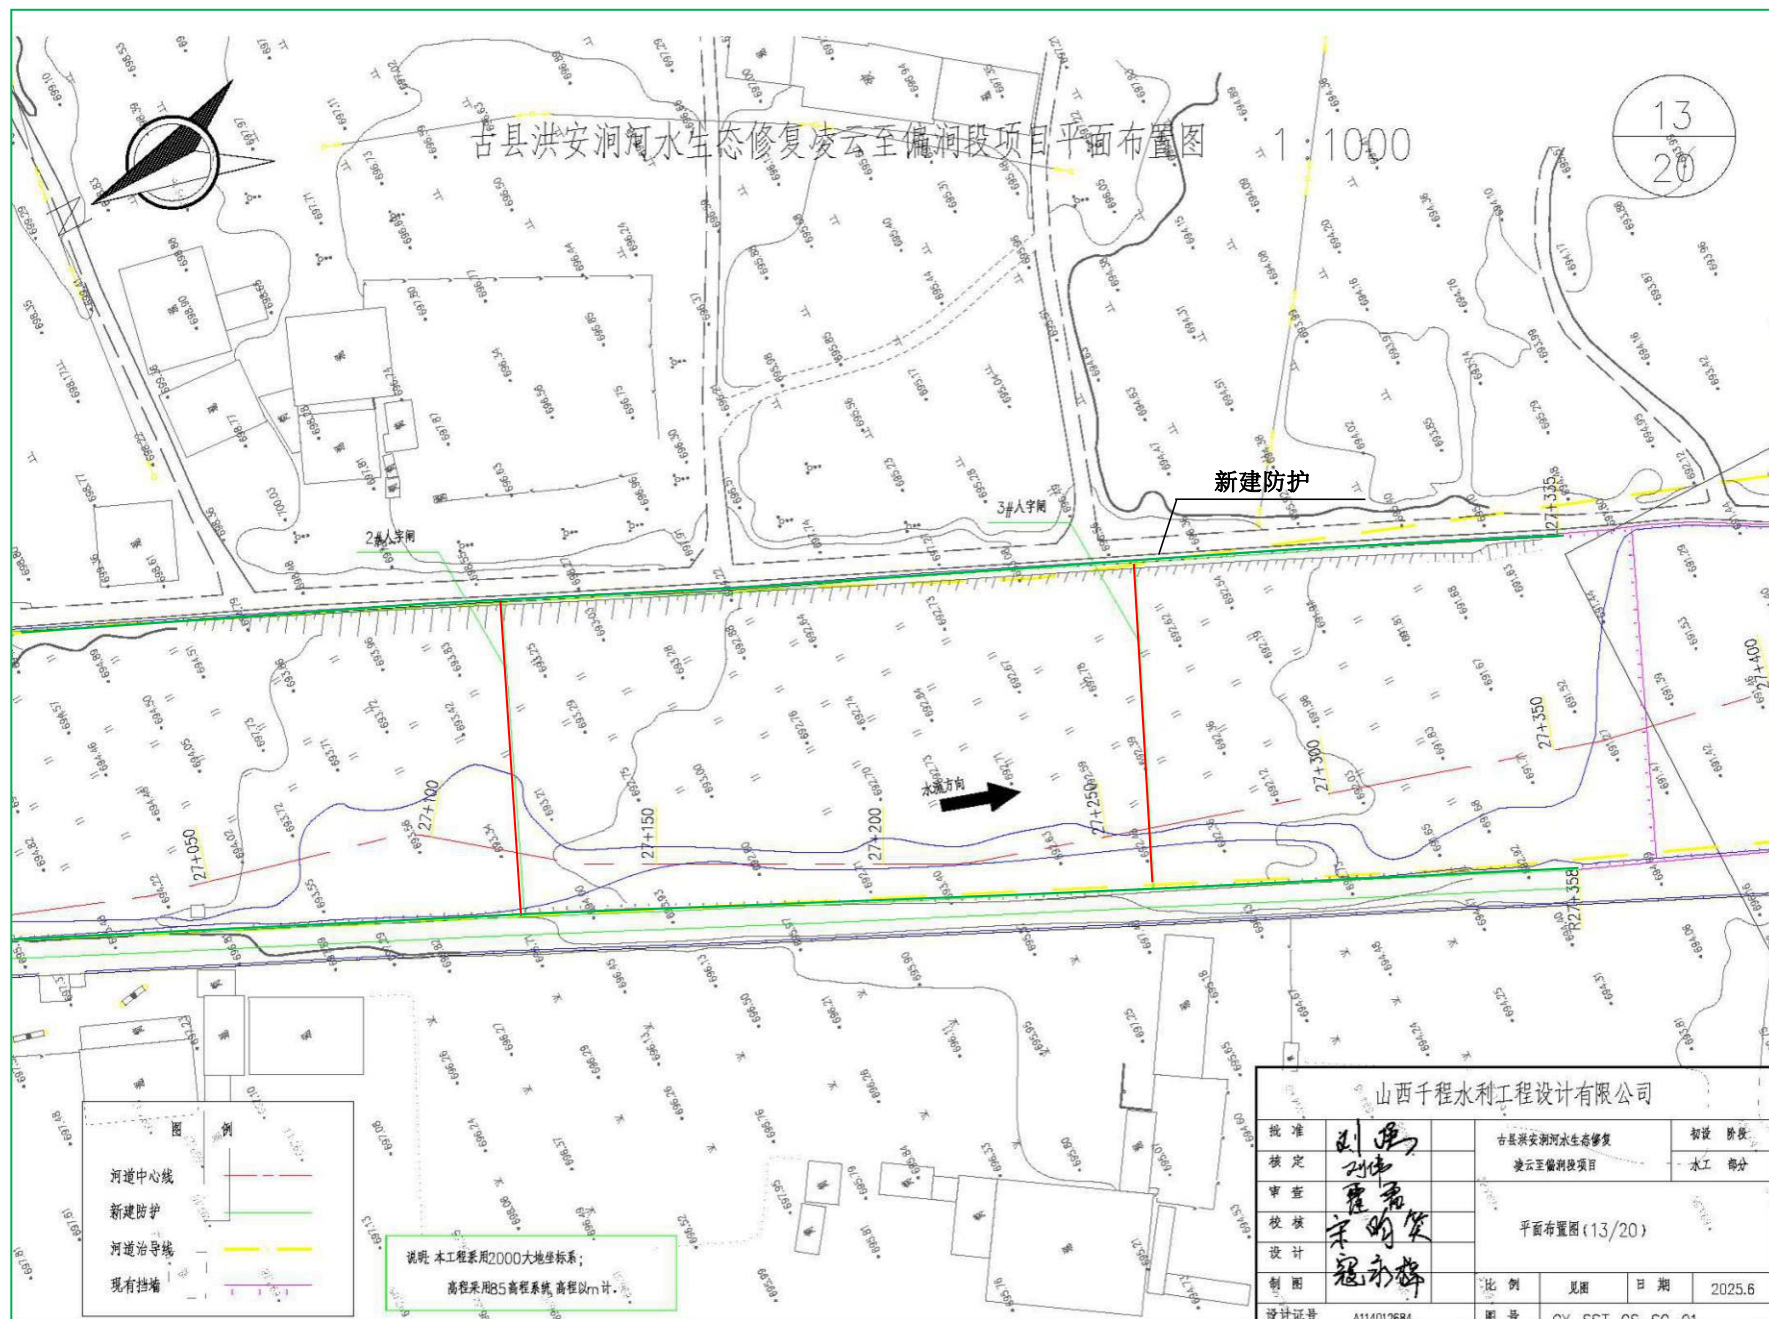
(13) 工程总平面布置图 (桩号 27+000-27+400)
